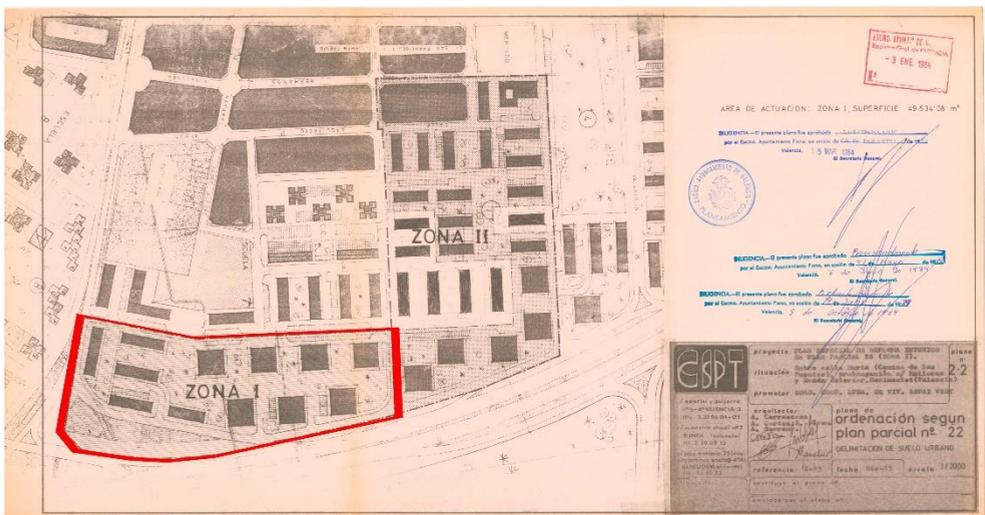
Plano de ordenación según el Plan Parcial nº22. Fuente: Archivo urbanístico del Ayuntamiento de Valencia.
